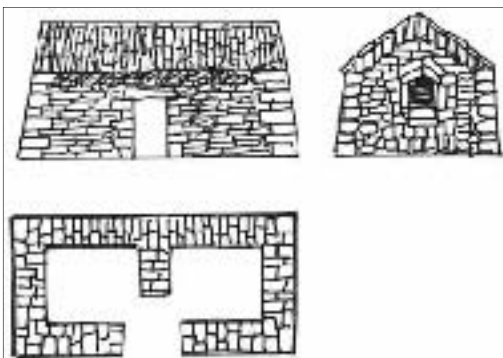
Construcciones de planta rectangular y techumbre a dos aguas.
